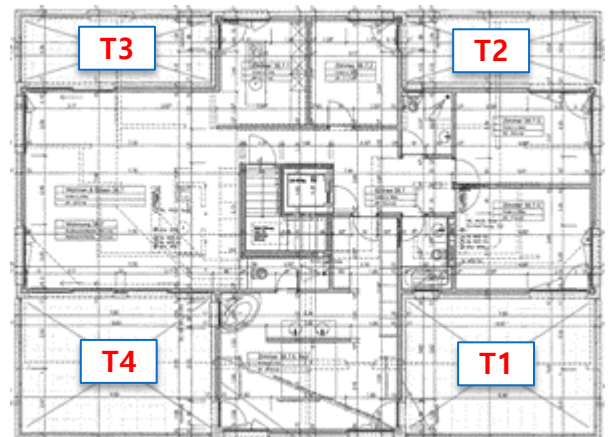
Haus 38 Dachgeschoss | Übersicht
